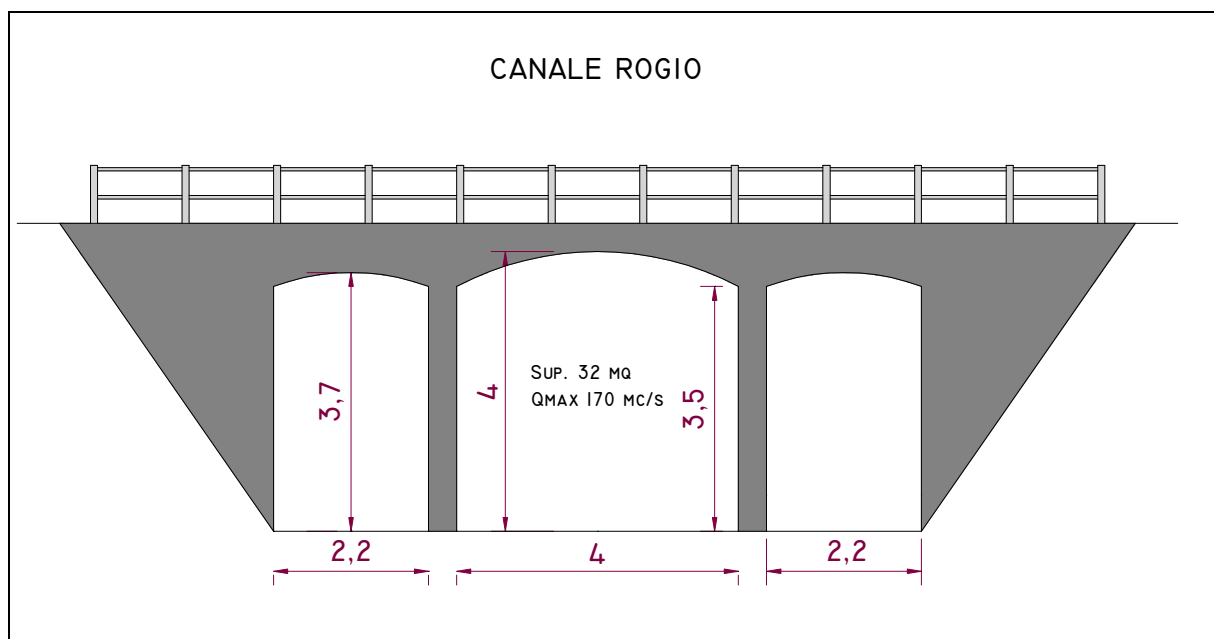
Sezione Canale Rogio (Foto 5 - Tav. 2)
